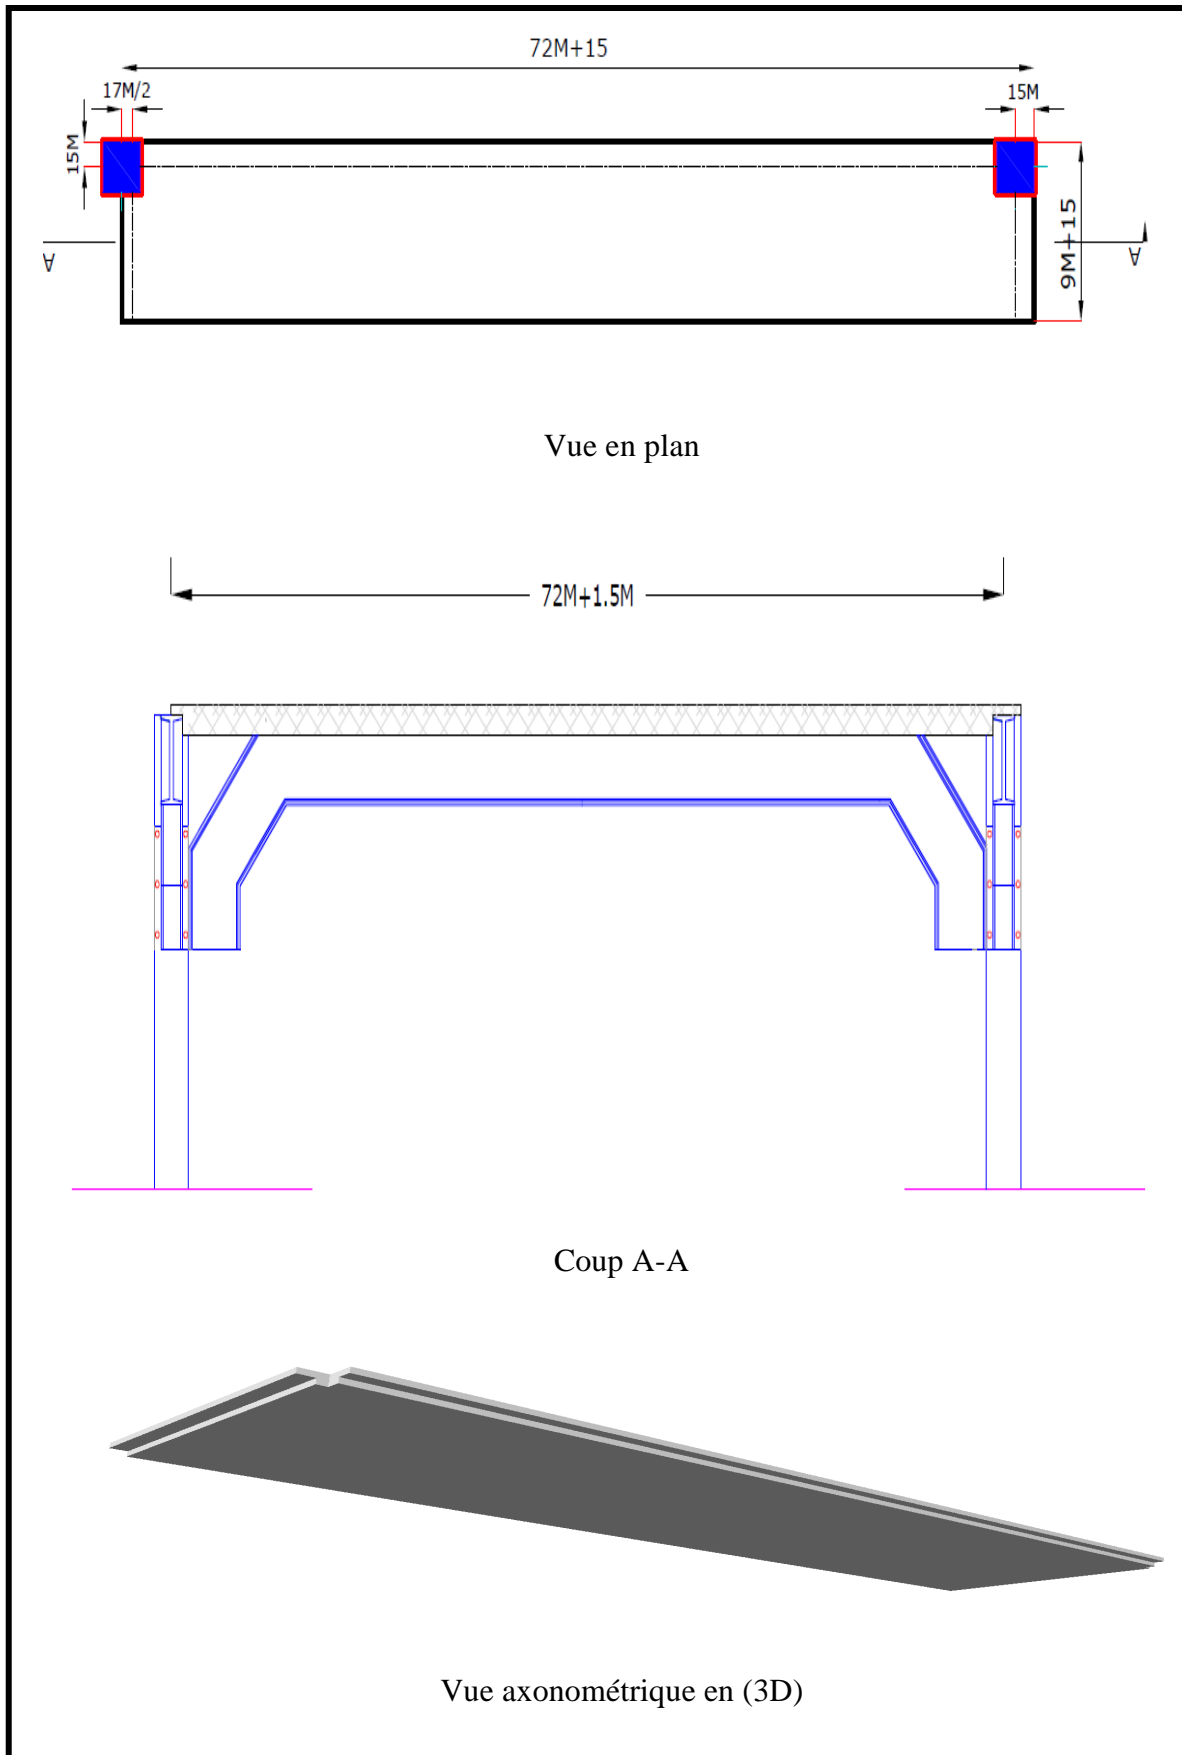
Dalle périphérique saillante de $n=15$ cas d'une façade dans les trois cotés
